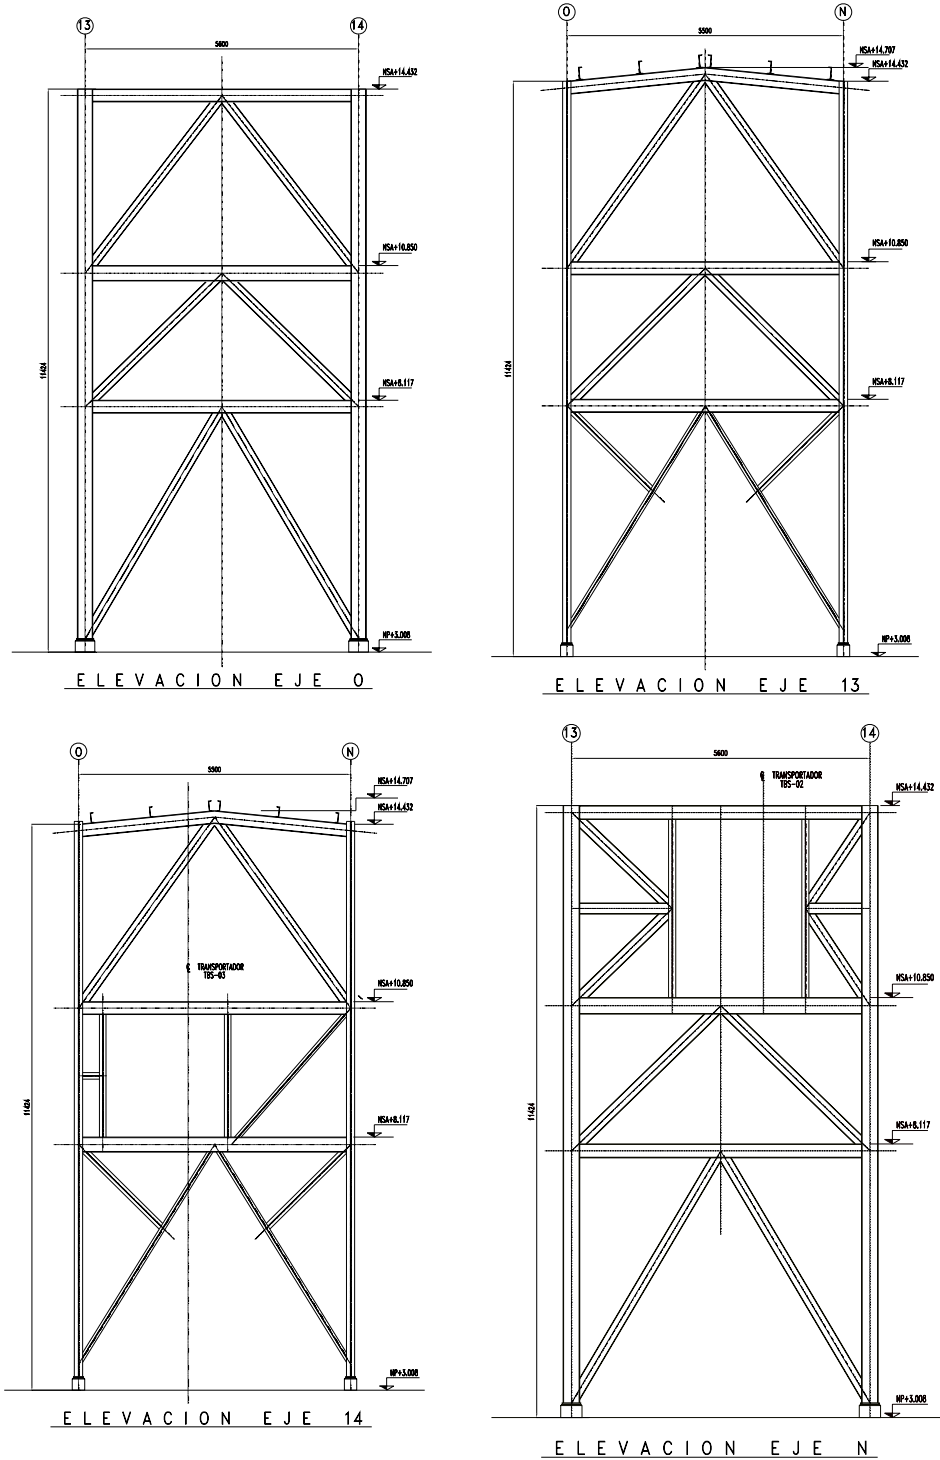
Elevaciones de Marcos Estructurales en Torre TT-3.
